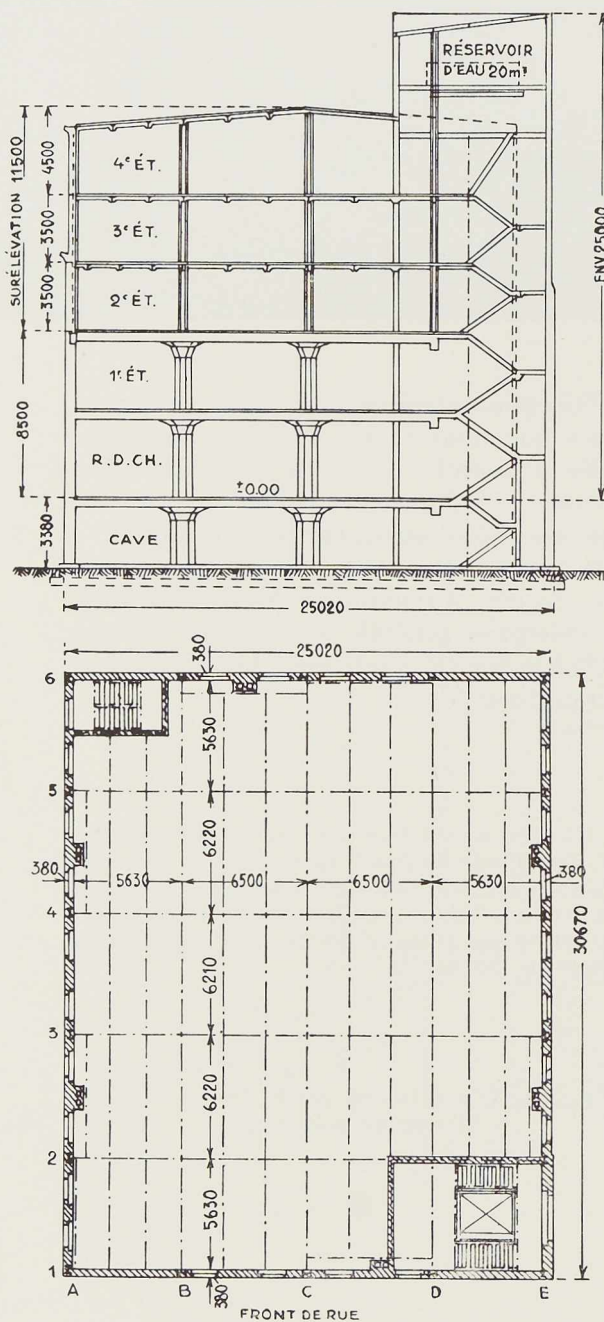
Élévation et plan de l'entrepôt après surélévation.
